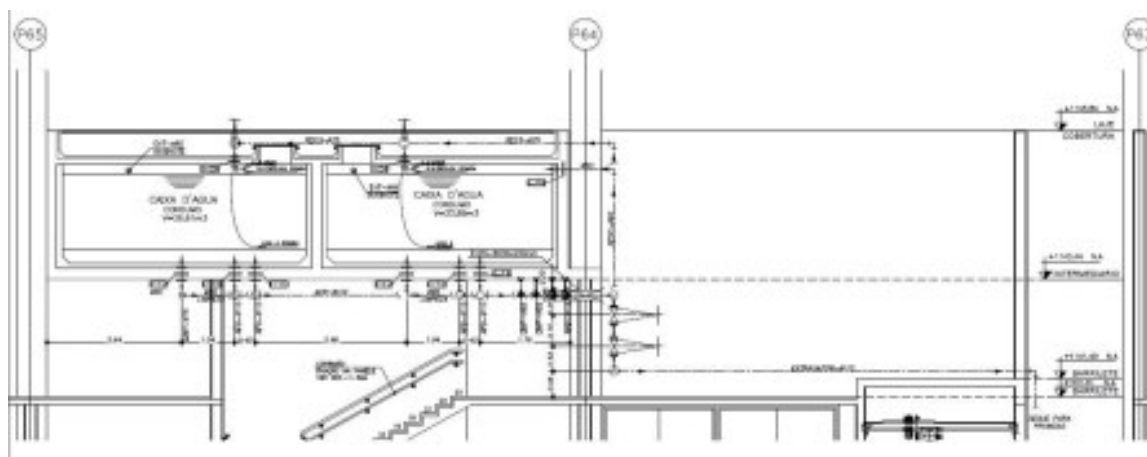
Corte esquemático de um dos 04 reservatórios elevados, localizados na laje do 2º pavimento.
